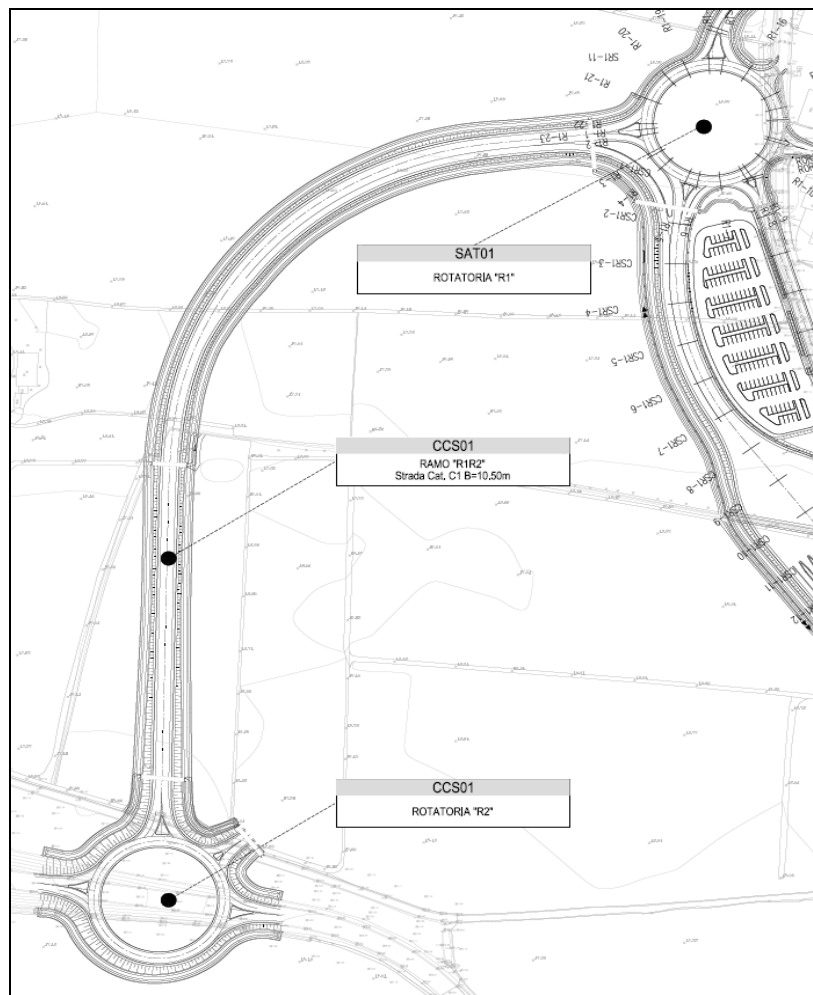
SCHEMA PLANIMETRICO C01
